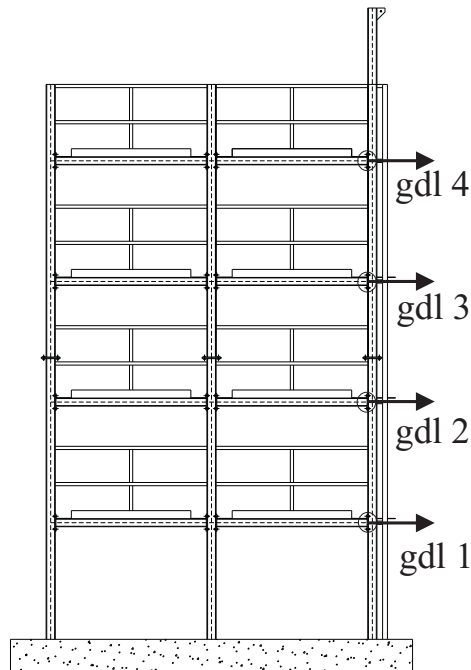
Posición de los acelerómetros y los gdl en cada planta.
